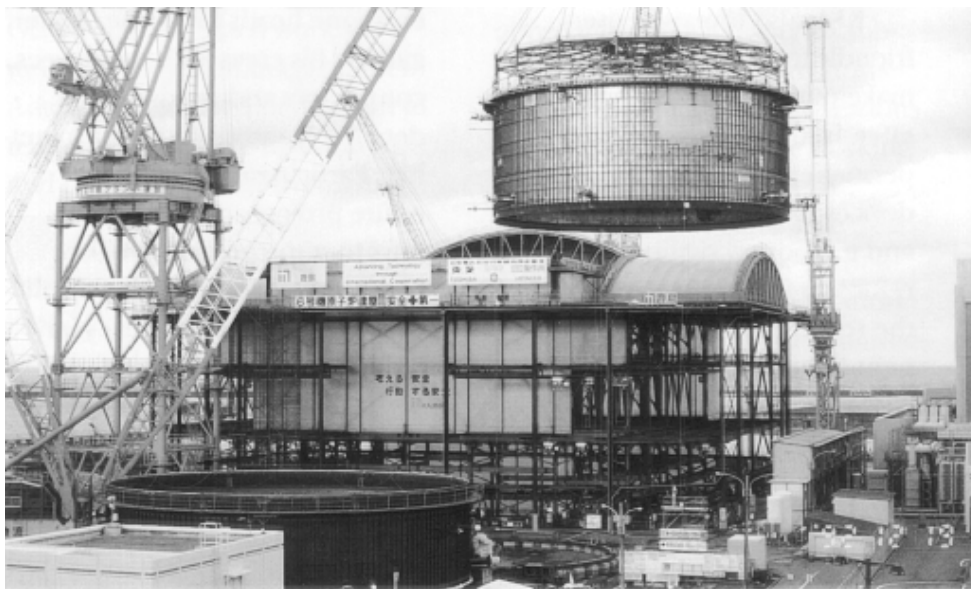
Imagen de la construcción de un ABWR en Japón (b).
